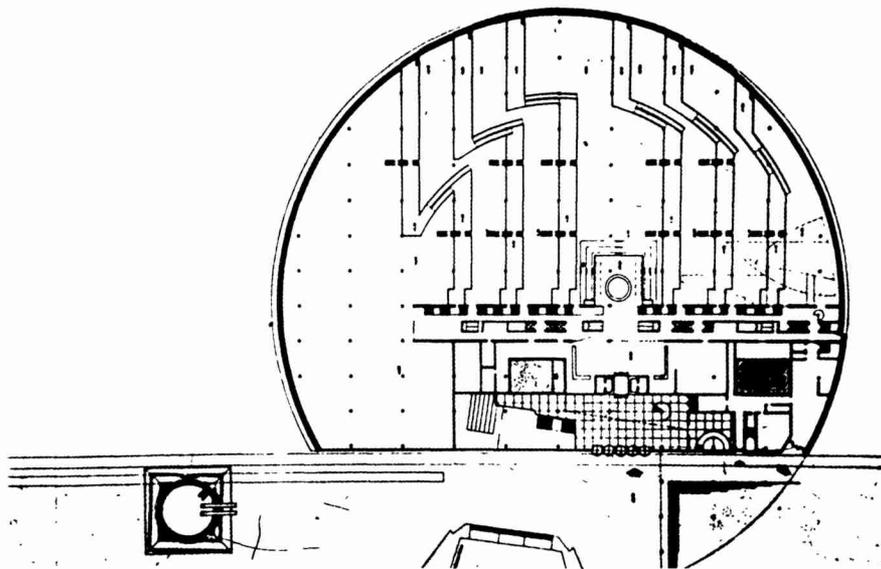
Alexandria, Grundriß, Erdgeschoß
